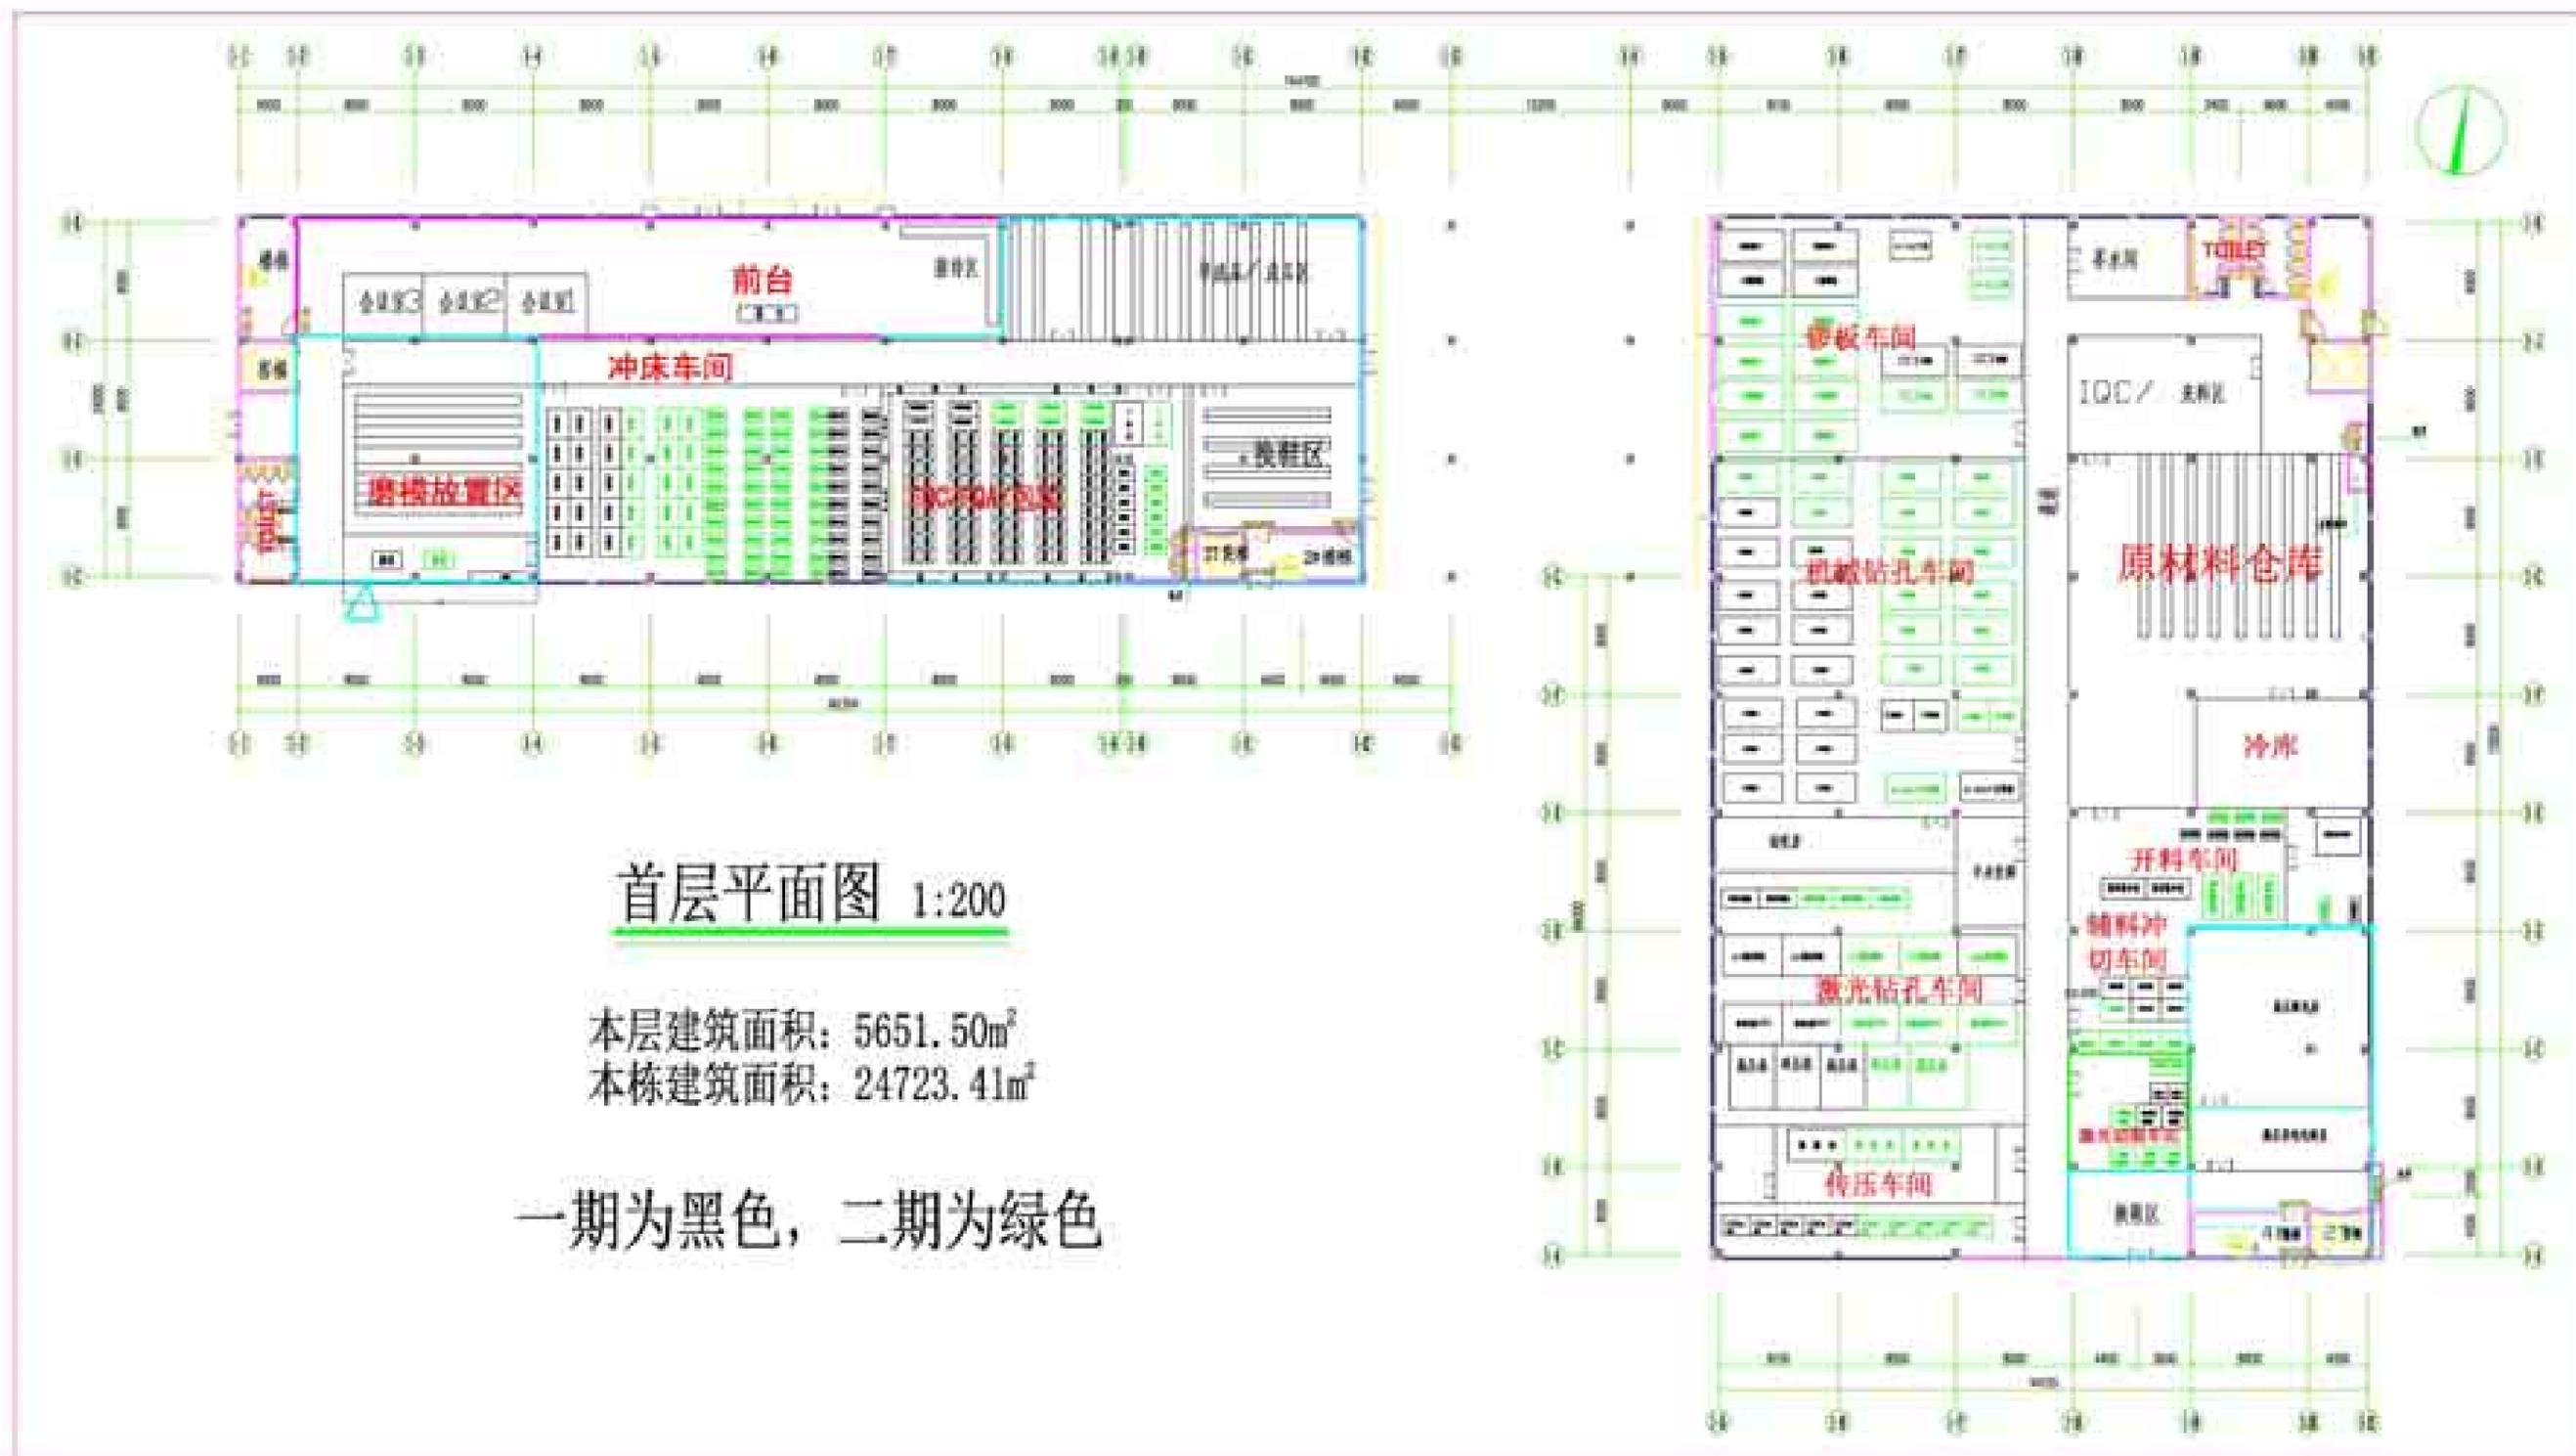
(a) 本项目 1# 厂房平面布置图 (一层)
